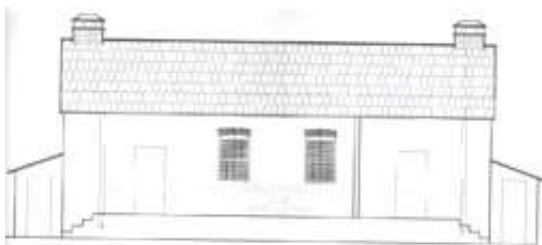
Extrait du plan du village minier de Djerissa (ENAU- Travail de groupe, novembre 2014).
